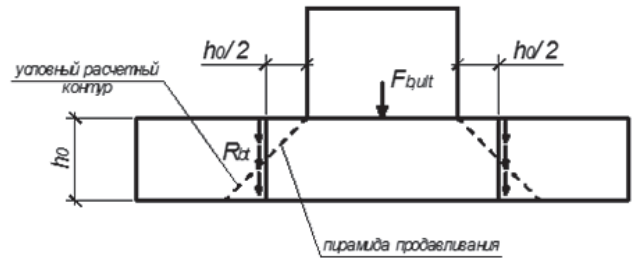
Схема для определения предельного продавливающего усилия плитной части ленточного железобетонного фундамента
